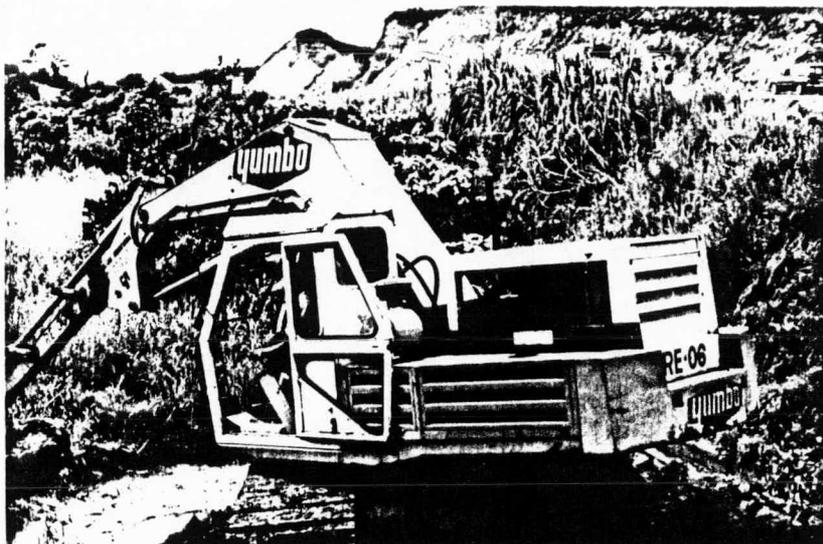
Retroexcavadora montada sobre carriles de oruga
